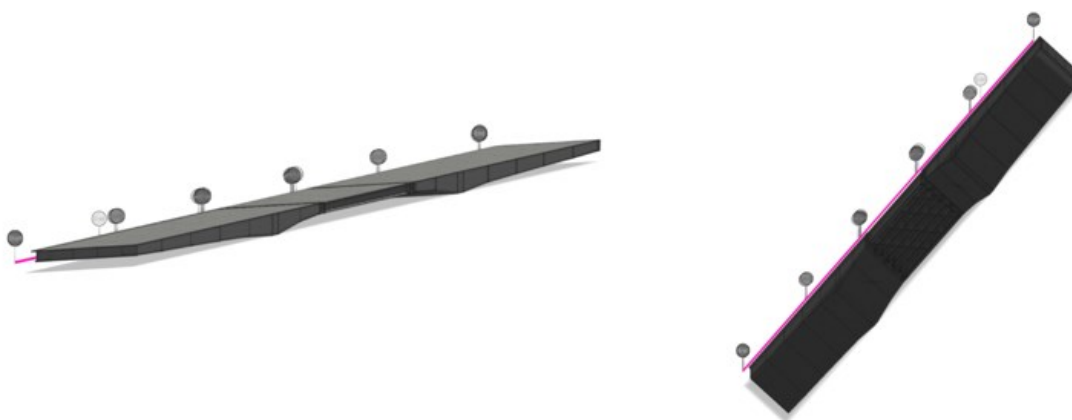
Impalcato calcestruzzo armato ponte Sud
